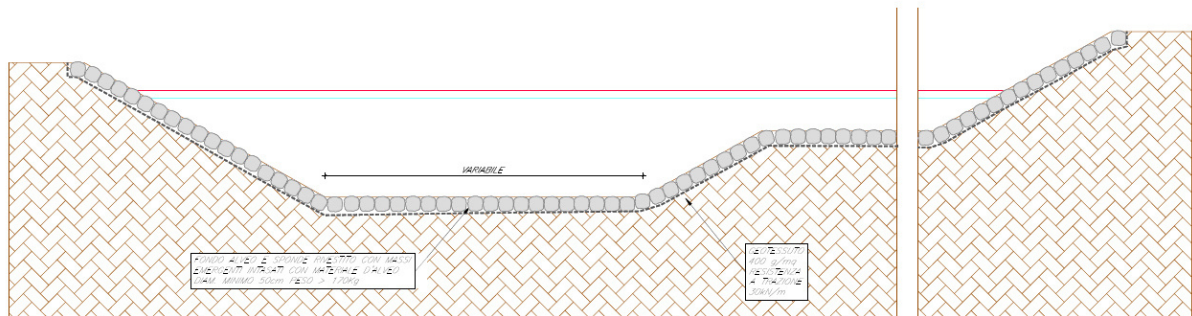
Sezione tipo sistemazione Pk 16+650.
